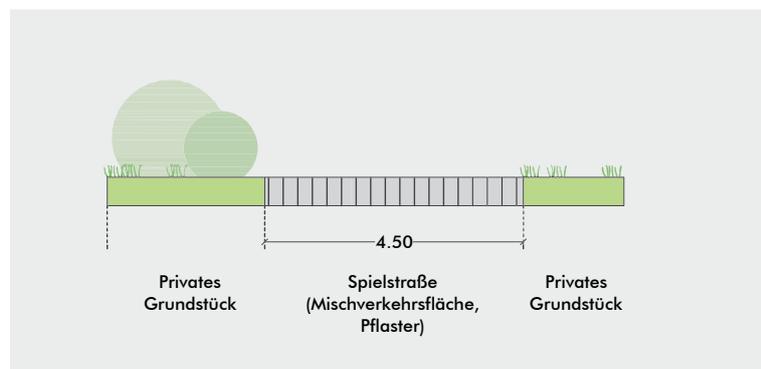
Schemaschnitt Straßenraum „Anger“ (Spielstraße), unmaßstäblich
